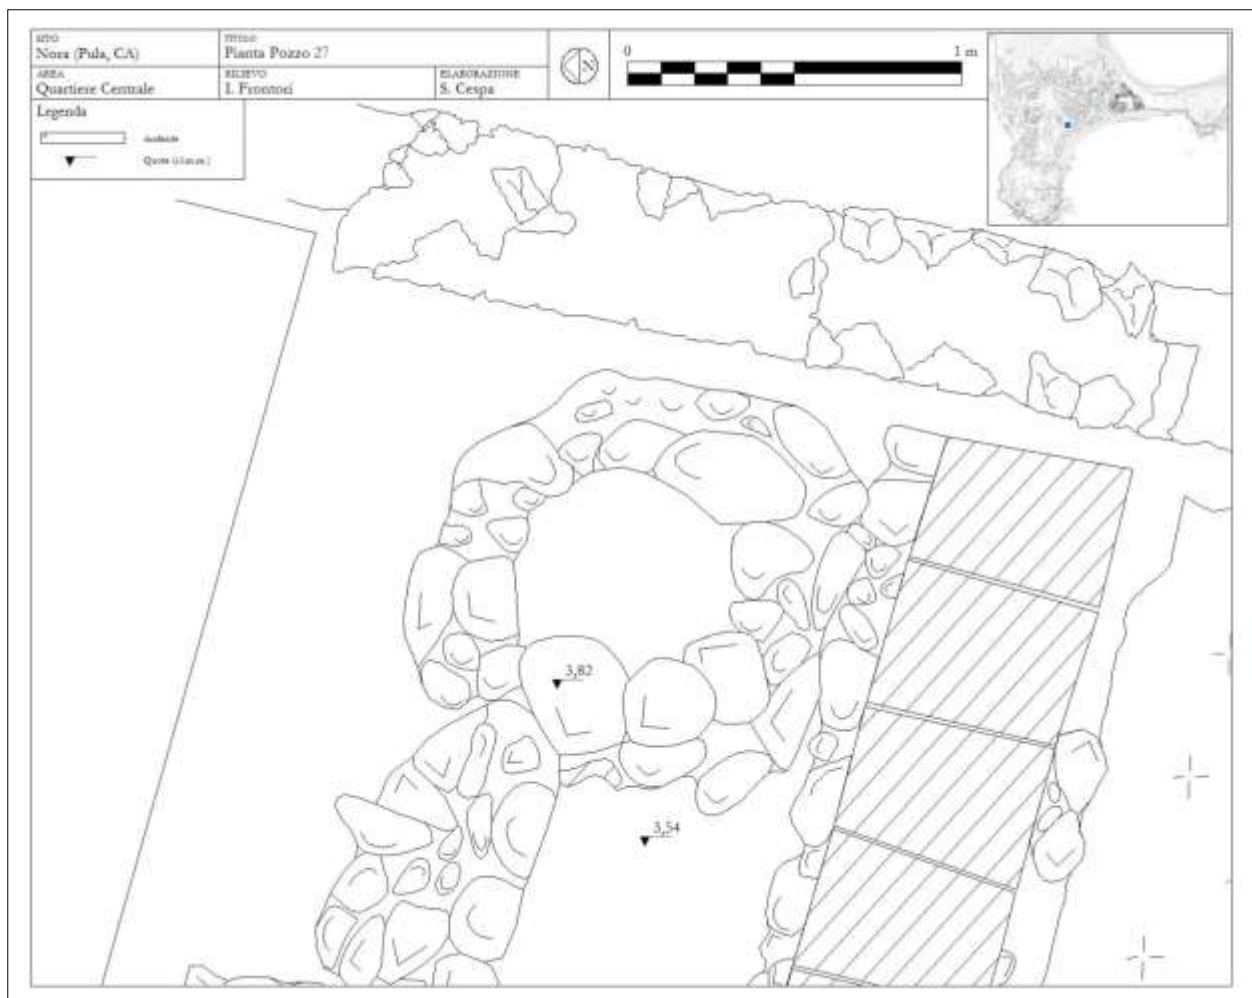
Pianta del pozzo 27 (rielaborazione da FRONTORI 2013).
